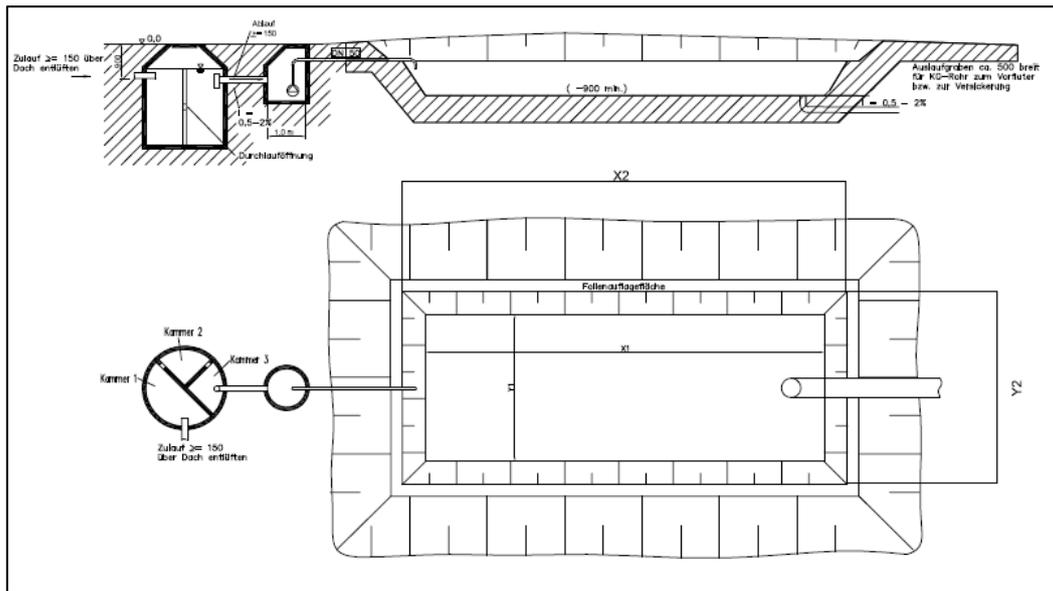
Beispiel: vertikal durchströmtes Beet mit Pumpenbeschickung
